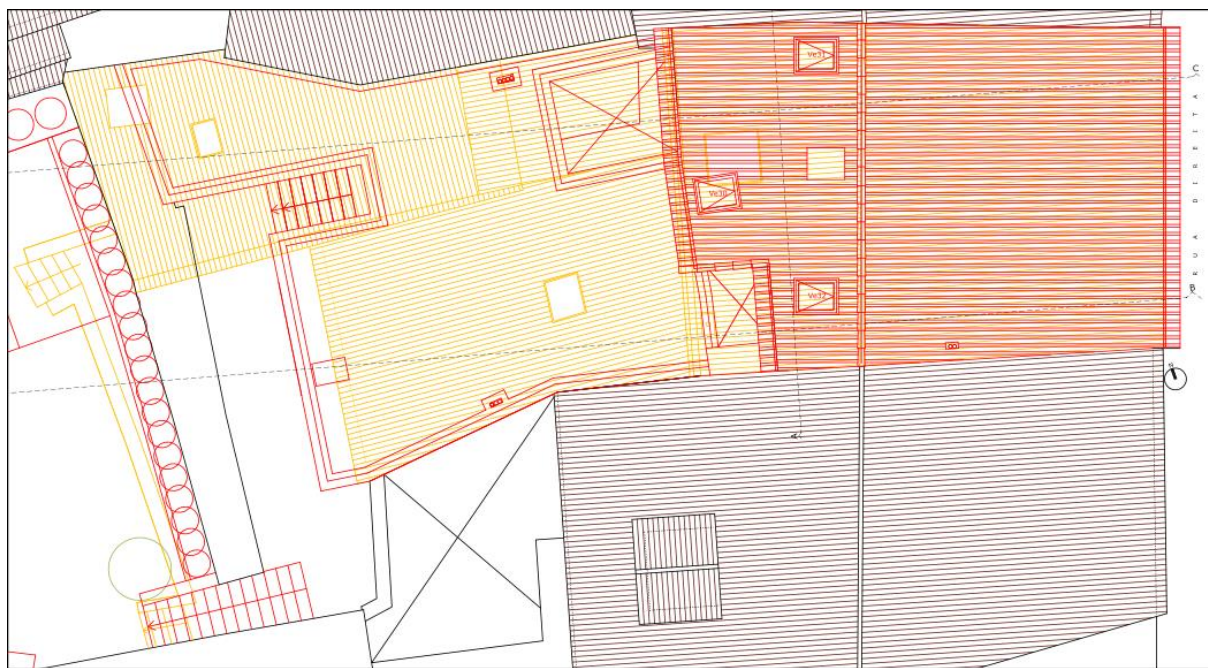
Planta da cobertura do edifício 2 em estudo
